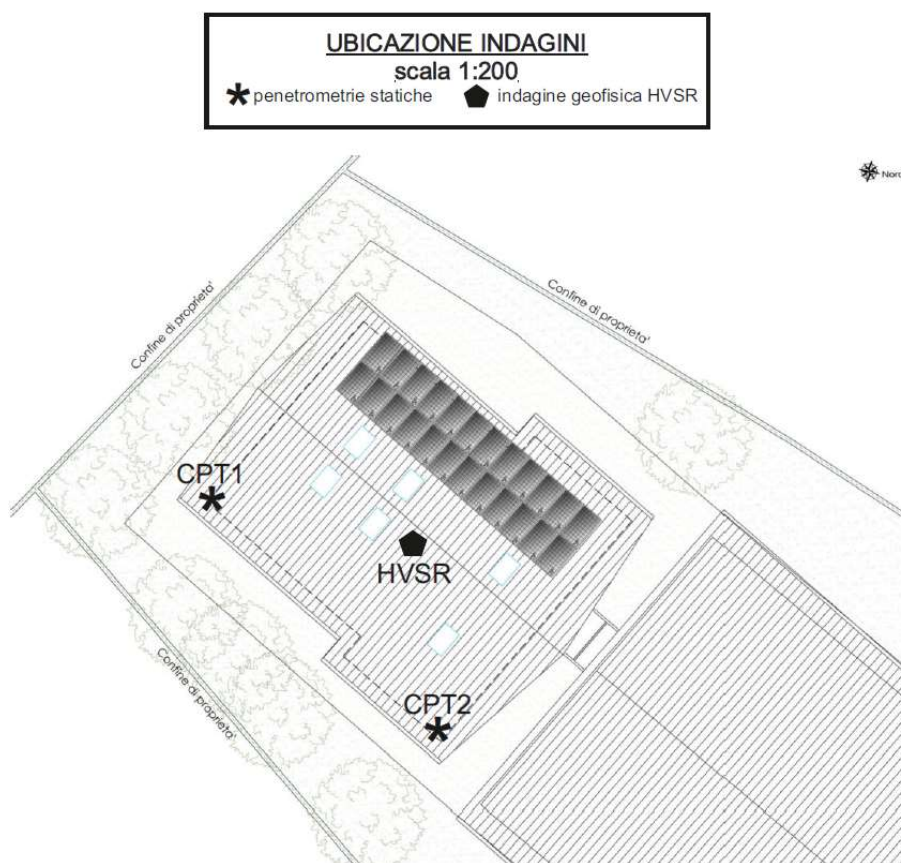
Localizzazione delle prove eseguite nell'area oggetto dell'intervento
